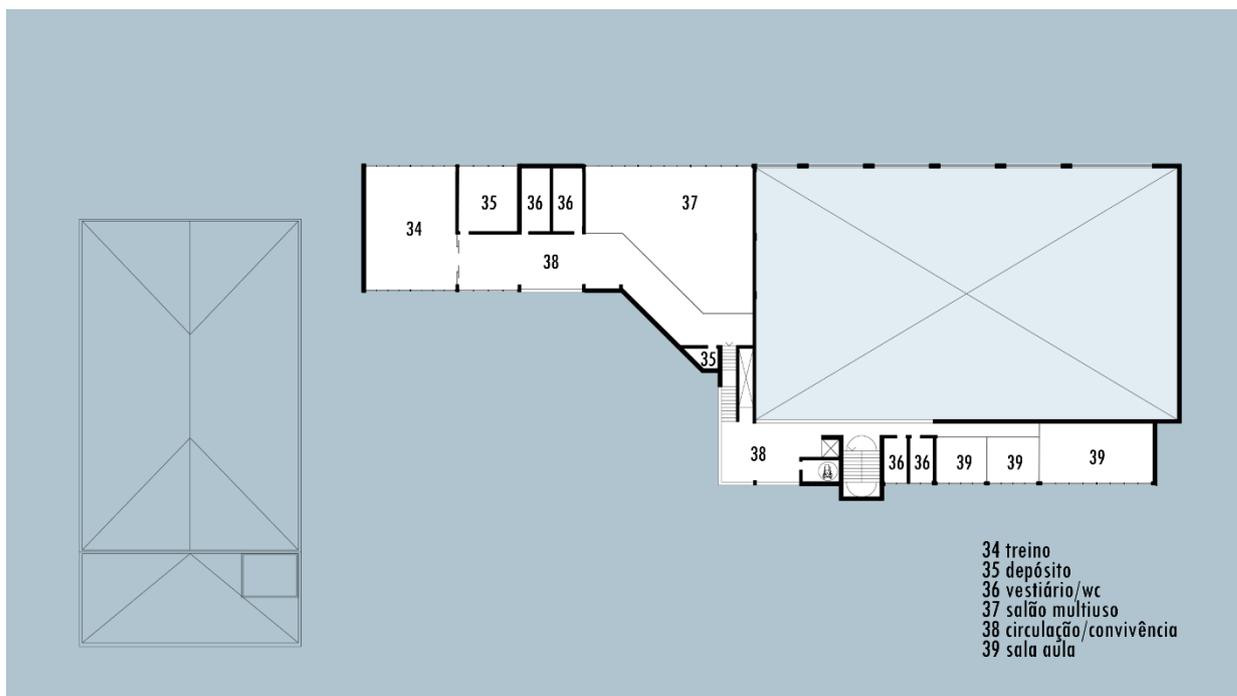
Planta Baixa Reabilitada - 2º PAVIMENTO. Fonte: produzido pela Autora.
